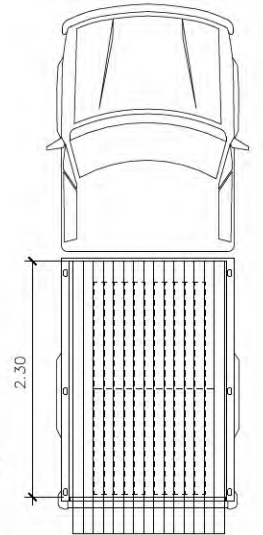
Piezas de columna ordenadas para transporte en cabina de Pick-up.
